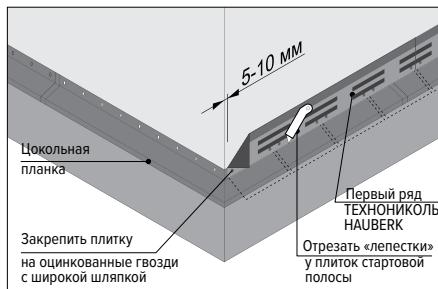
Монтаж стартовой полосы фасадной плитки
